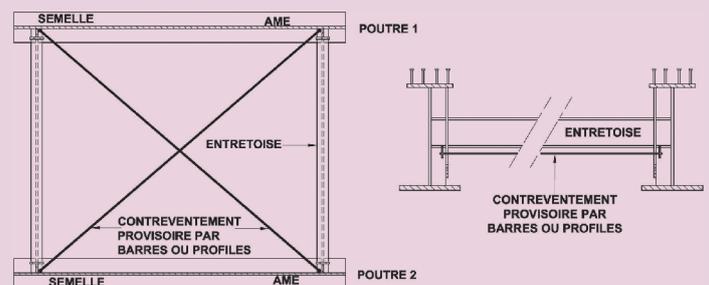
Schéma de principe d'un contreventement provisoire (cas d'un bipoutre à entretoises)
